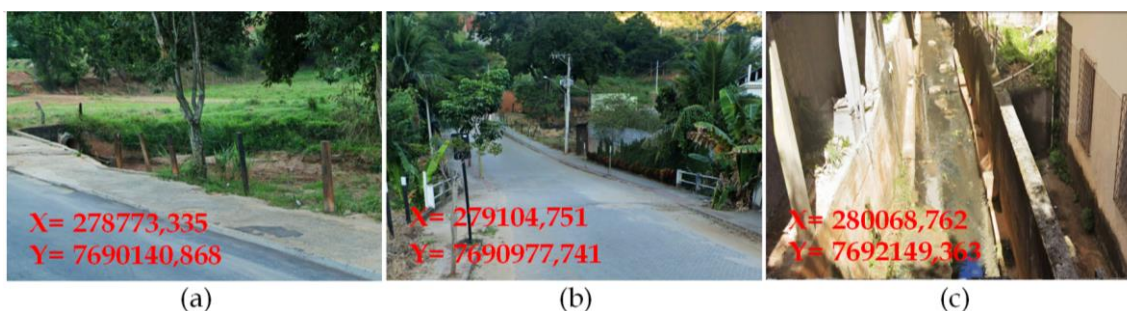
Identificação de obras de engenharia em áreas propensas a inundações: manilha e rodovia (a); ponte (b) e edificações e canalização (c). Fonte: *Google Earth (Street View)*.
